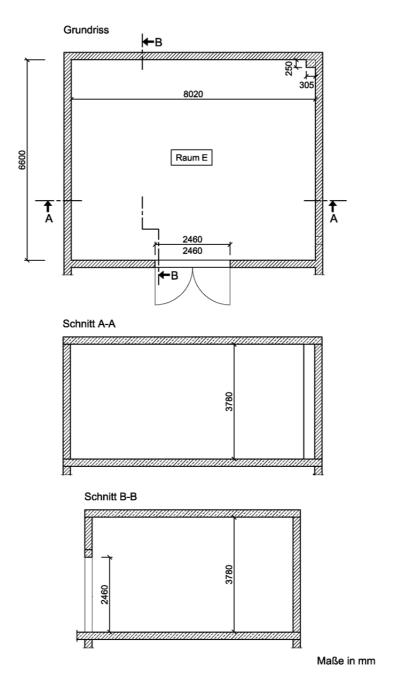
Grundriss und Schnitte des Hallraums.
